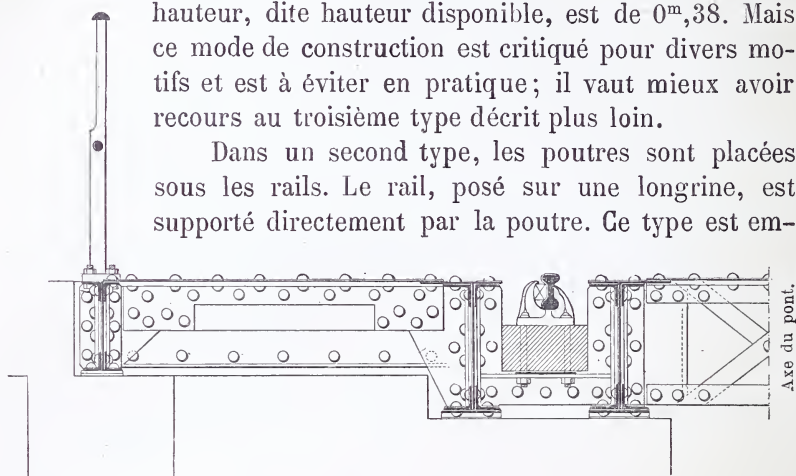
Pont avec poutres jumelles. (Demi-coupe transversale.)
